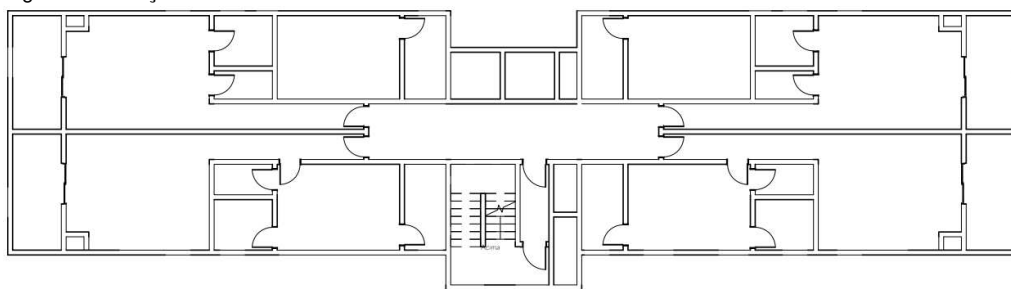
Planta baixa pavimento tipo. (Fonte: Autor, 2023)
